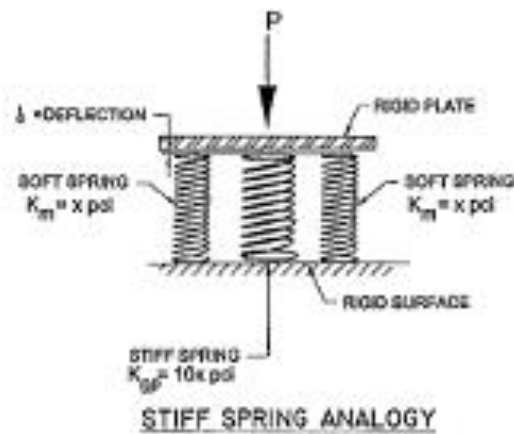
Soporte de carga del Geopier, Adaptado de "GEOPIER foundation And Soil reinforcement manual" por Fox and Comwell (1998).
